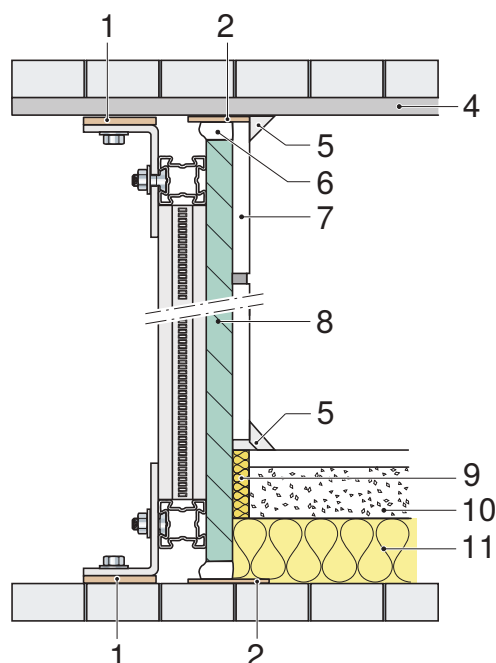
Sistema d'installazione Geberit GIS con esecuzione del montaggio prima e dopo l'applicazione dell'intonaco di fondo
